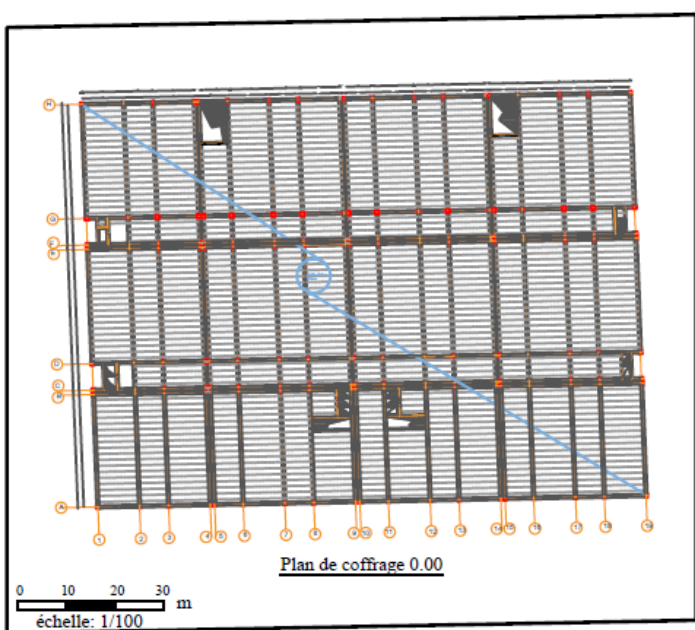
Plan de coffrage +0.00/Source : Traiter par l'auteur.
